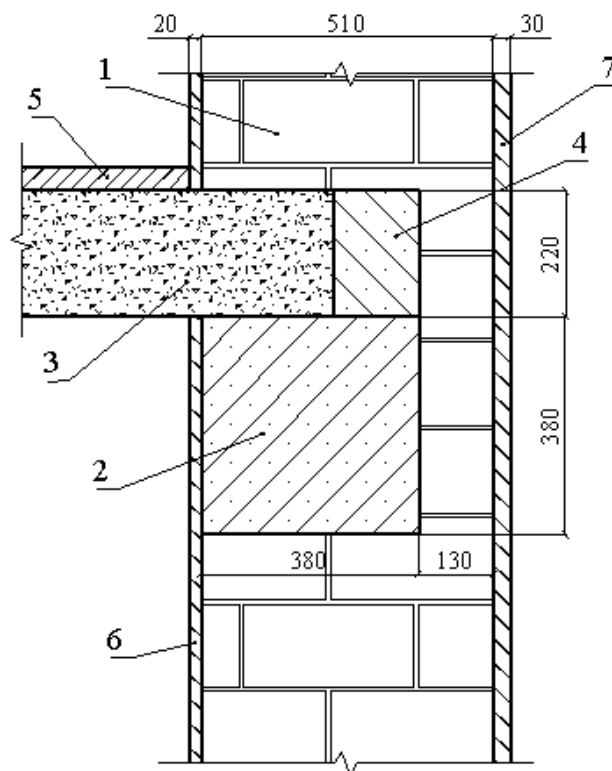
Узел опирания перекрытия на ригель, размещённый в кирпичной кладке наружной стены
